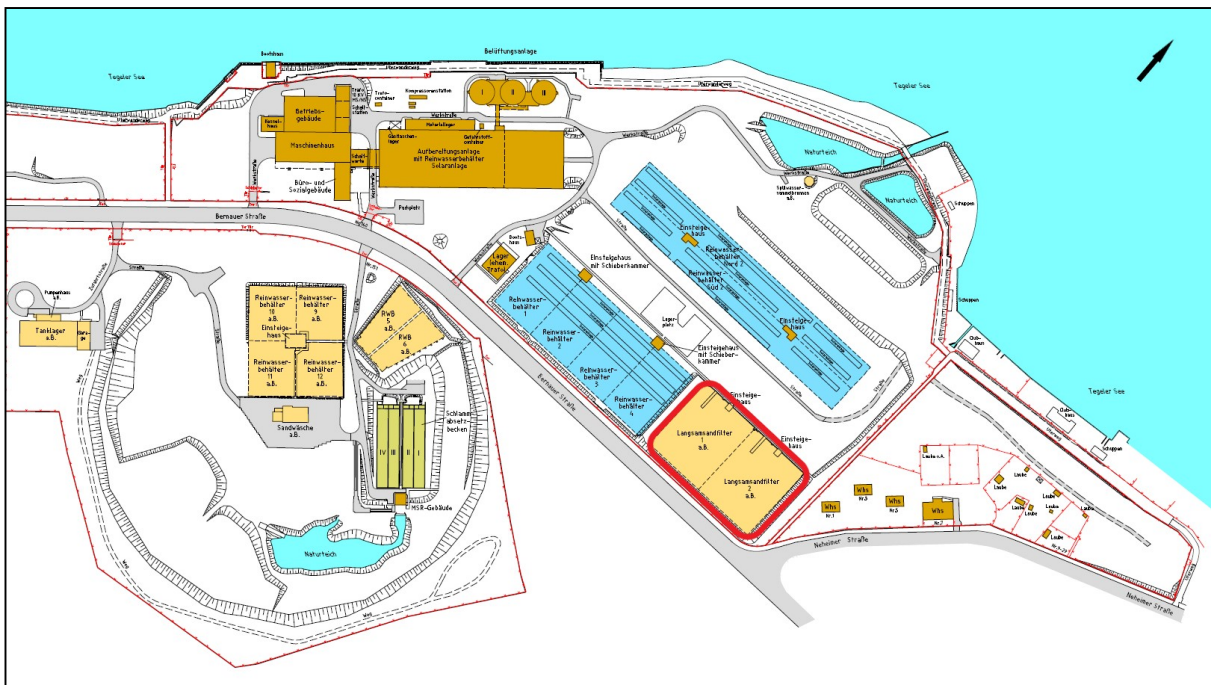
Grundriss des WW Tegel mit Hervorhebung der beiden unter Schutz stehenden Langsandsandfilter (nach Bauwerkskarte der BWB)
